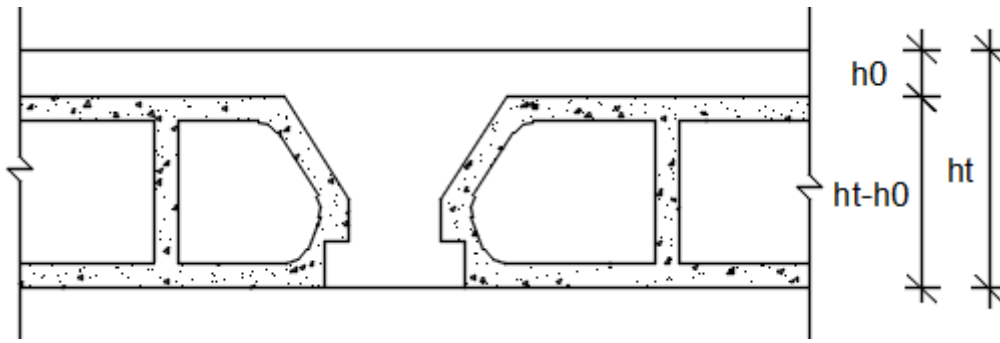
Coupe transversale d'un plancher à corps creux.
